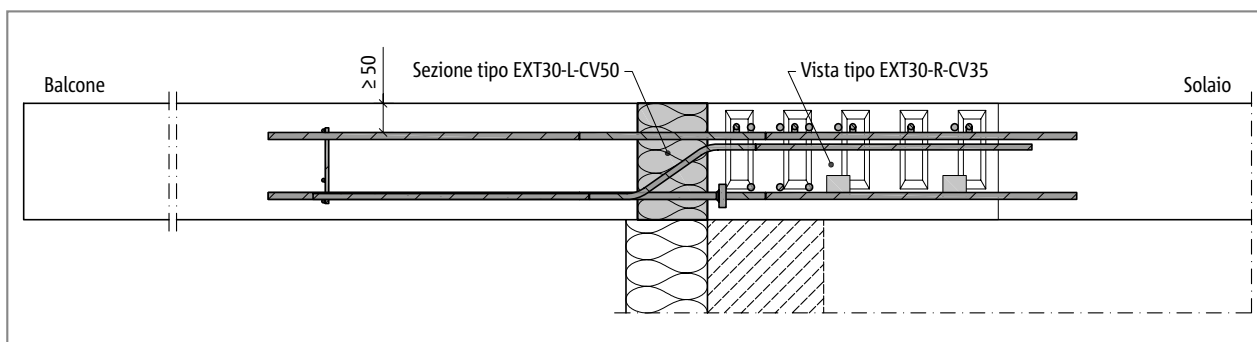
Schöck Isokorb® tipo EXT: angolo esterno con cappotto (vista EXT-L-CV50; sezione EXT-R-CV35)
